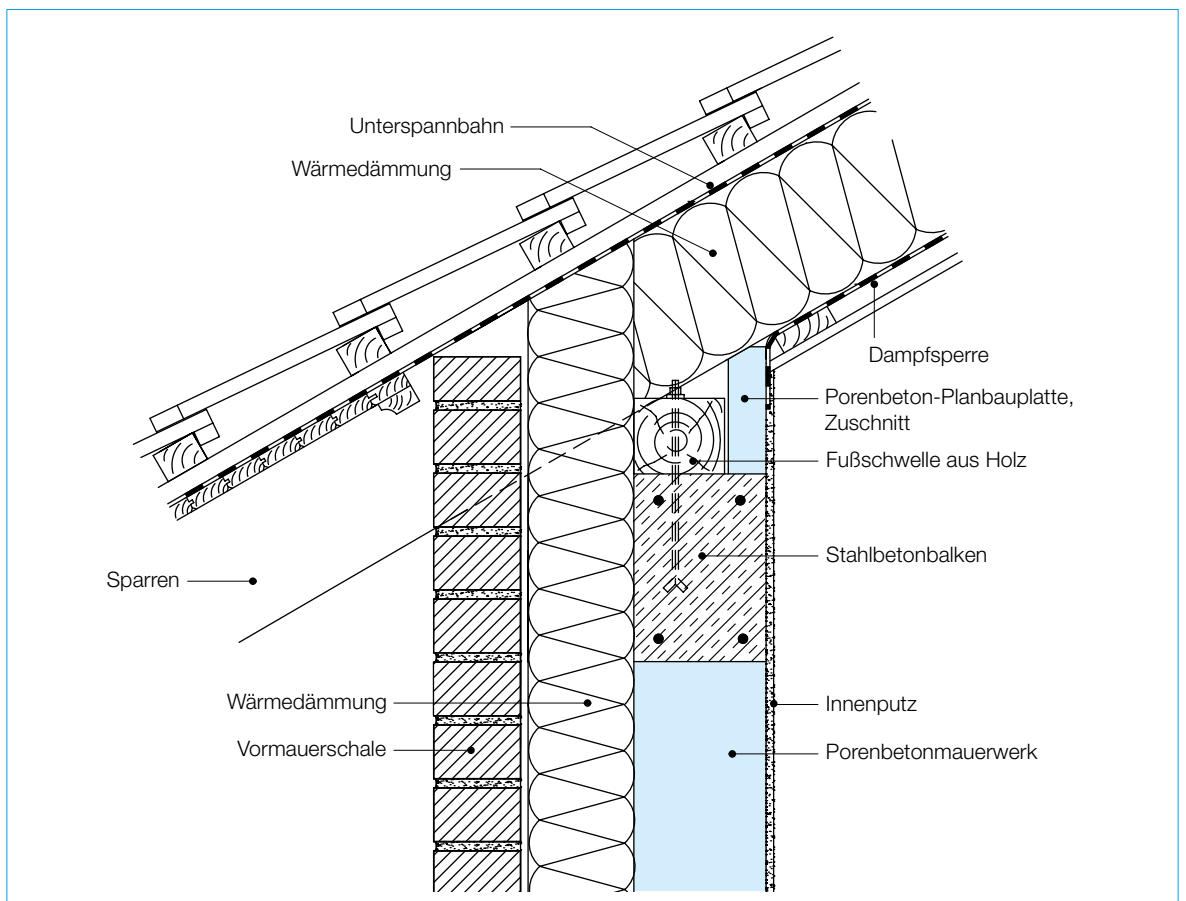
Zweischalige Außenwand aus Porenbetonmauerwerk mit Wärmedämmung und Vormauerschale – Dachanschluss (Traufschnitt)
